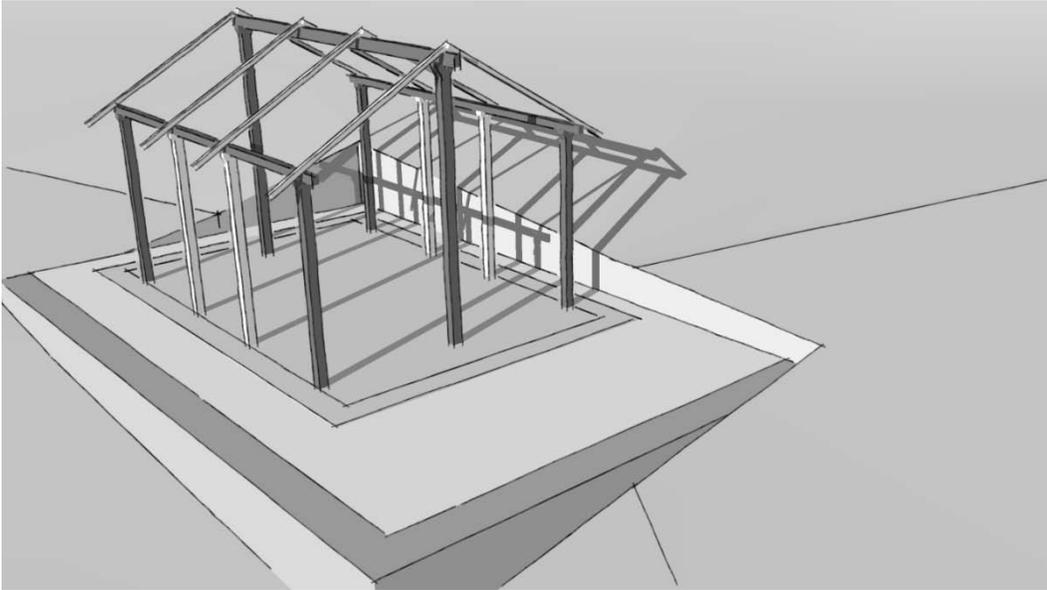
Colocación de la estructura de refuerzo (partida "Estructura").
